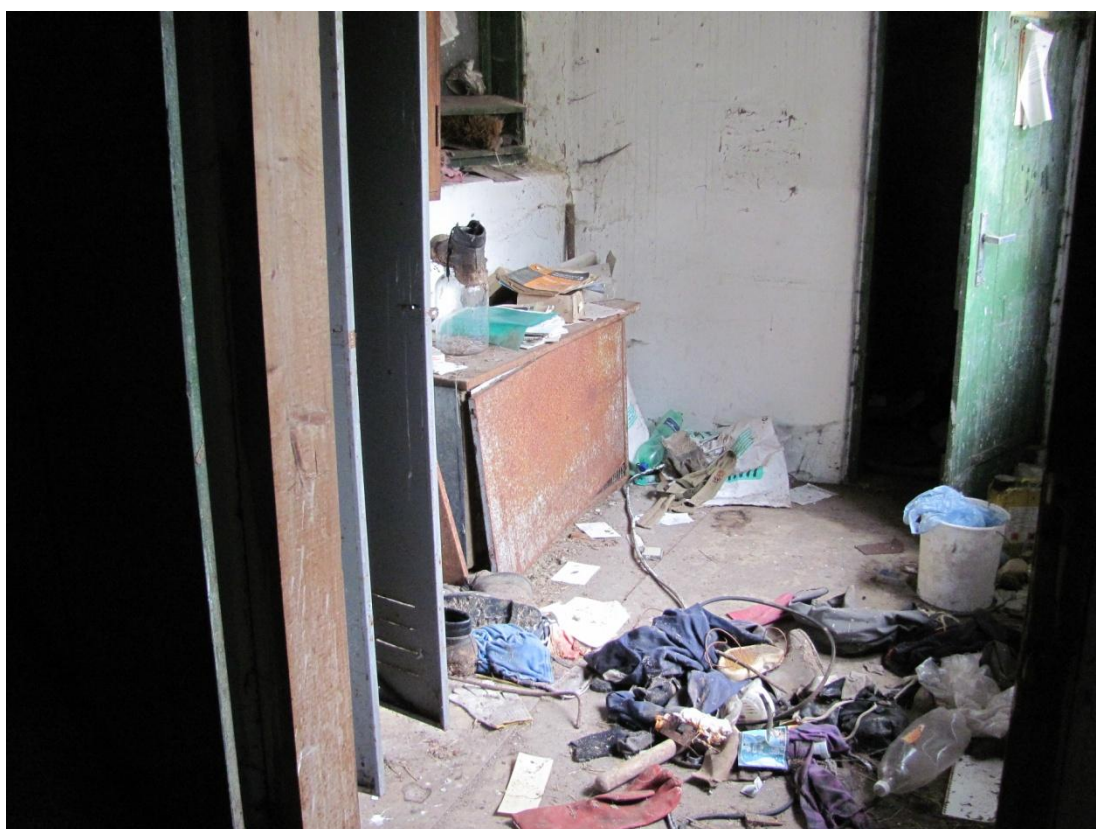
pohled do místnosti pro obsluhu kravína (zdroj: vlastní fotografie)
